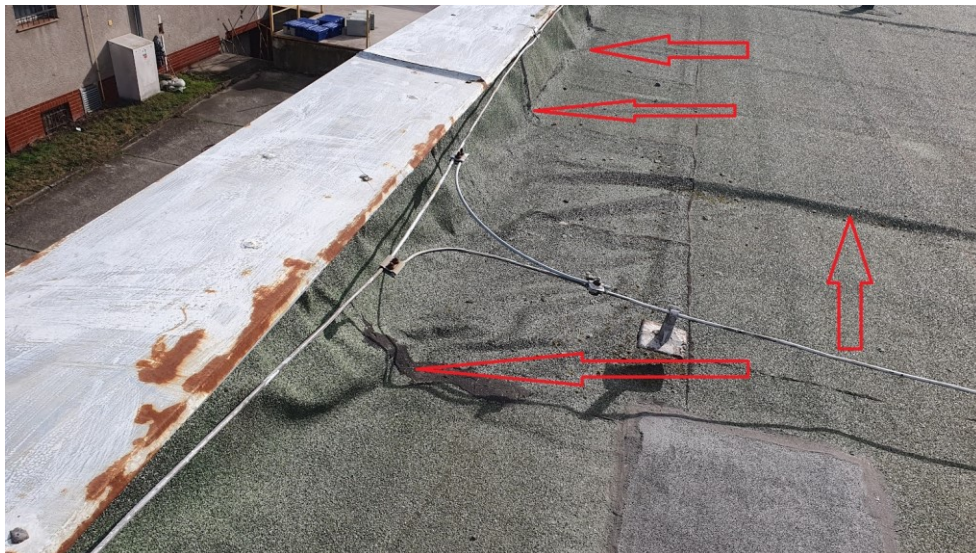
deformace SBS pásu od atikové konstrukce
